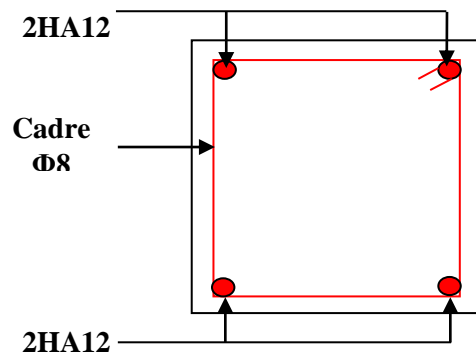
Schéma de ferrailage de la poutre de chaînage
